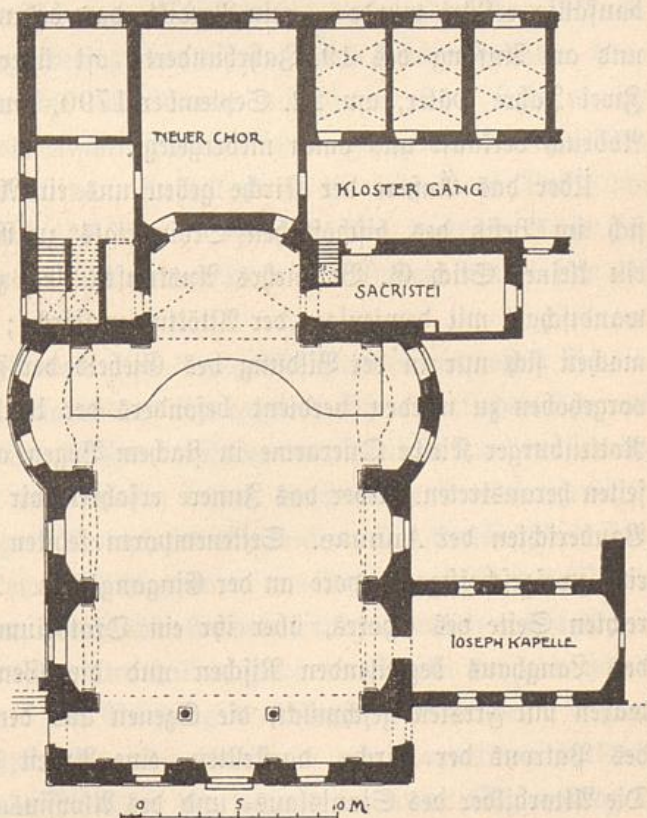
Altötting. Magdalenenkirche. Grundriß.
